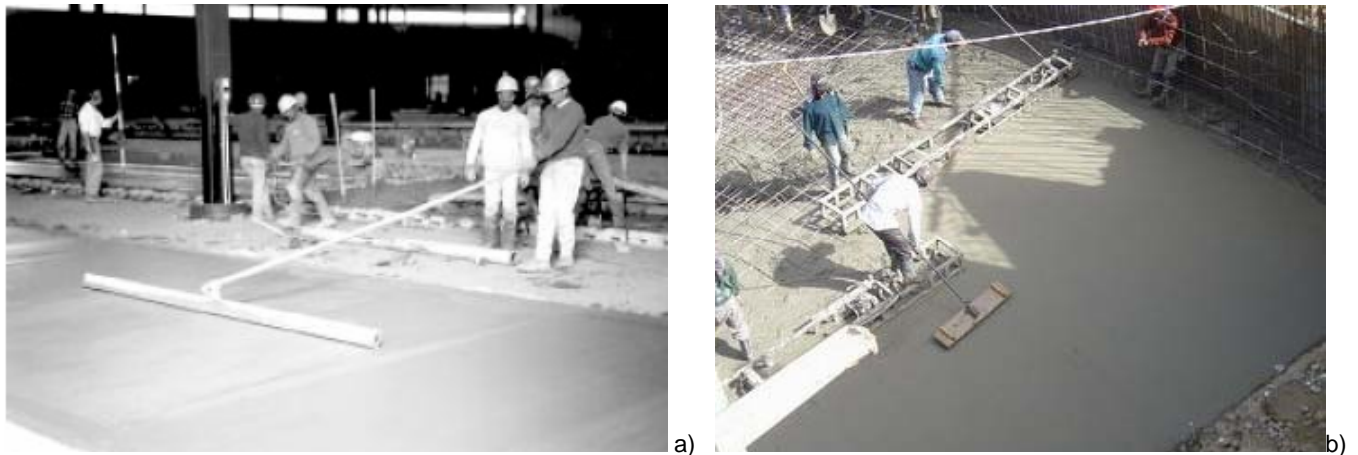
a) Acabado de una losa con aplanadora de mango largo, utilizada par alcanzar lugares que no se pueden llegar con el brazo b) Acabado de un pavimento con regla vibratoria y luego aplanadora de madera.
